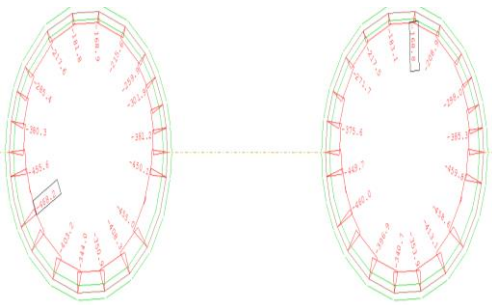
Эпюра продольных усилий, возникающая в конструкции железобетонной обделки
